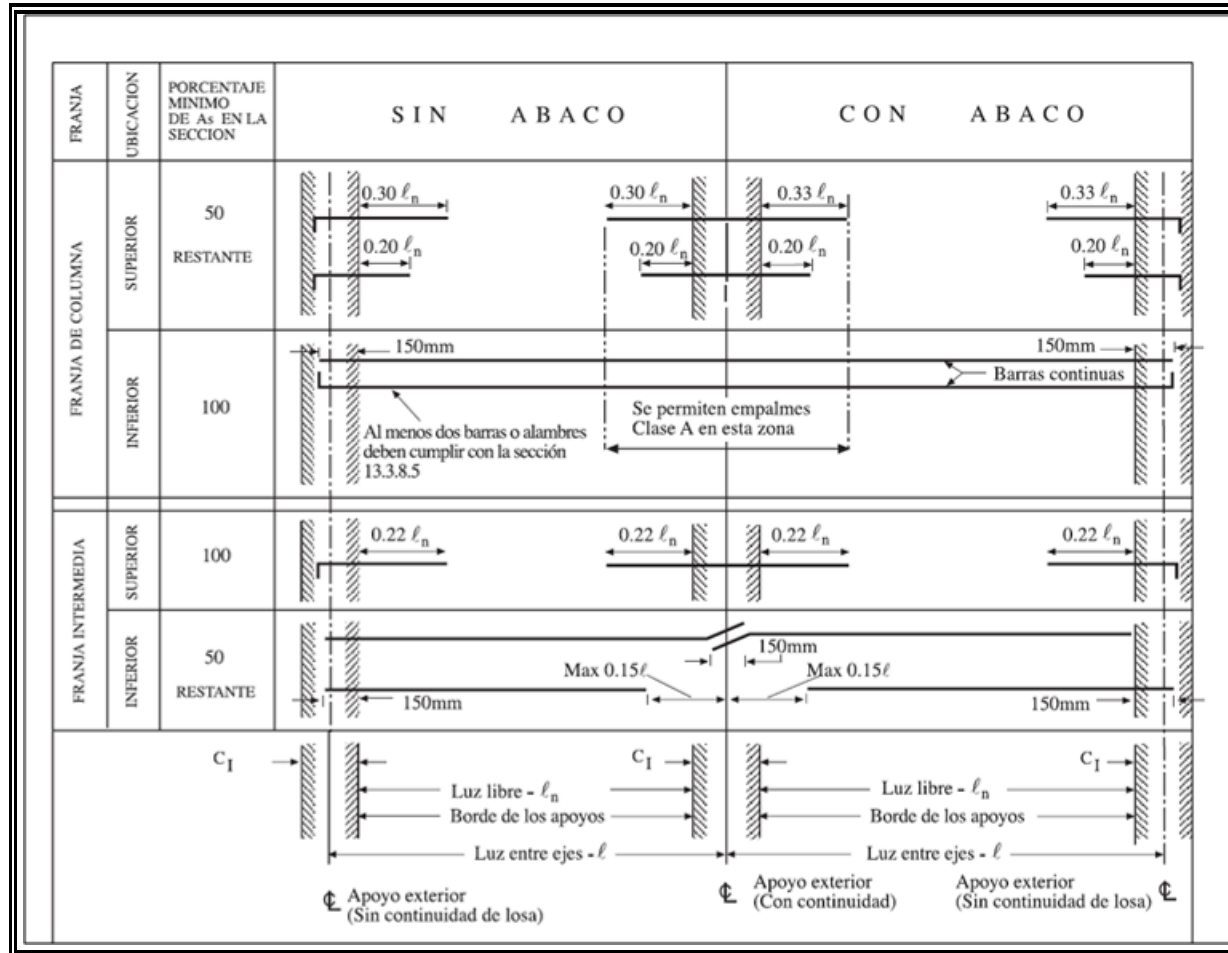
Extensiones mínimas del refuerzo en losas sin vigas
